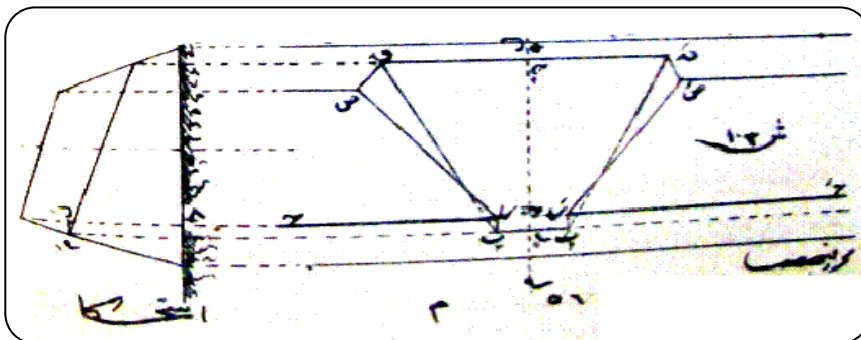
مسقط أفقي تحليلي لمزغل البندقية (رسم بمعرفة الباحث)
